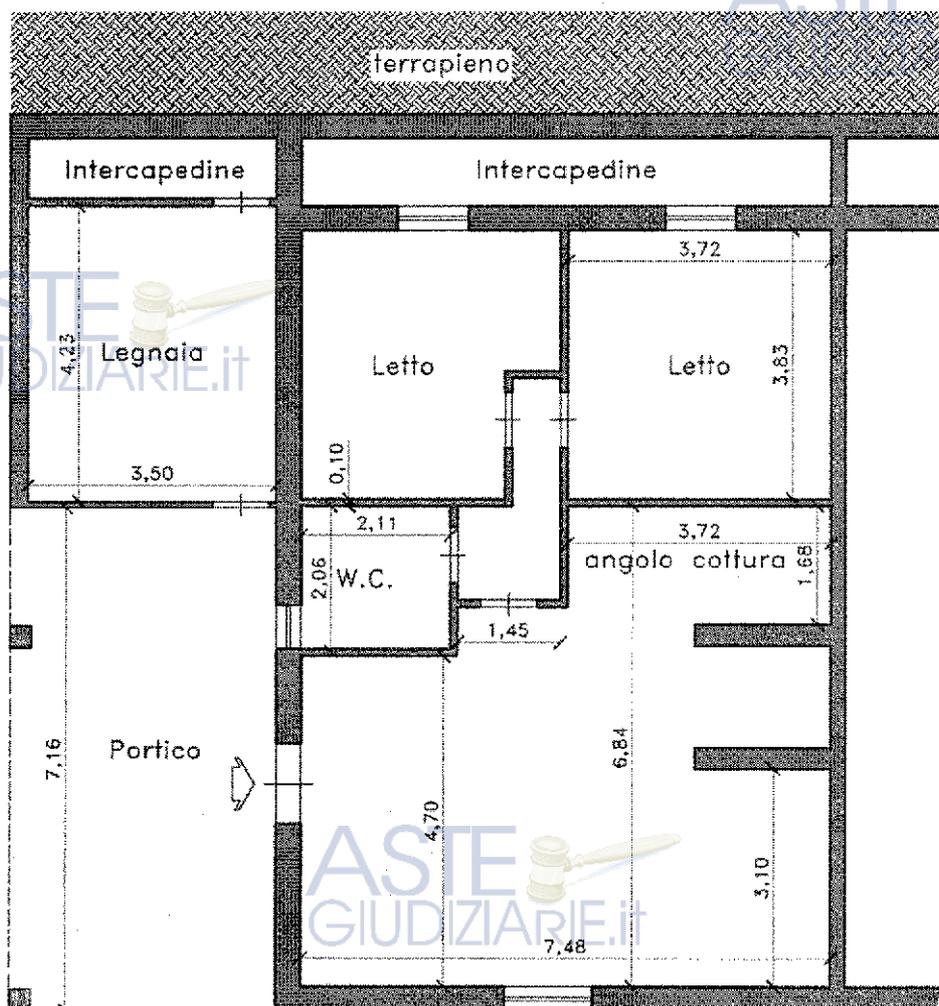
Planimetria quotata appartamento piano terra redatta a seguito del rilievo eseguito
